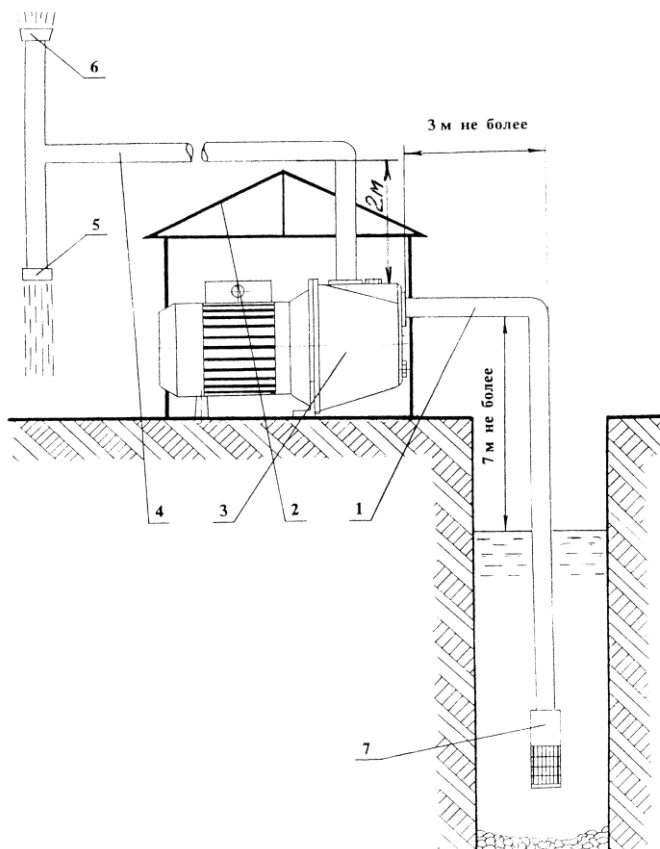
Схема установки насоса для перекачки воды из открытого водоема.
